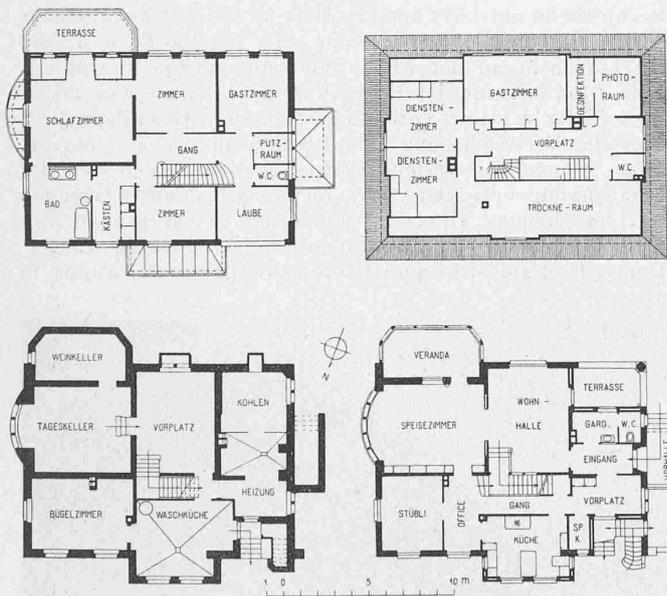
bis 4. Grundrisse des Hauses Dr. Frischknecht. — 1 : 400.
